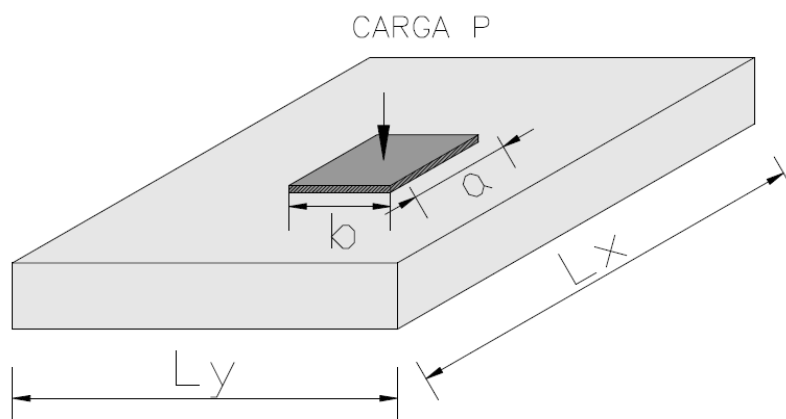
Detalhe da proporção entre a chapa e os vãos das lajes
